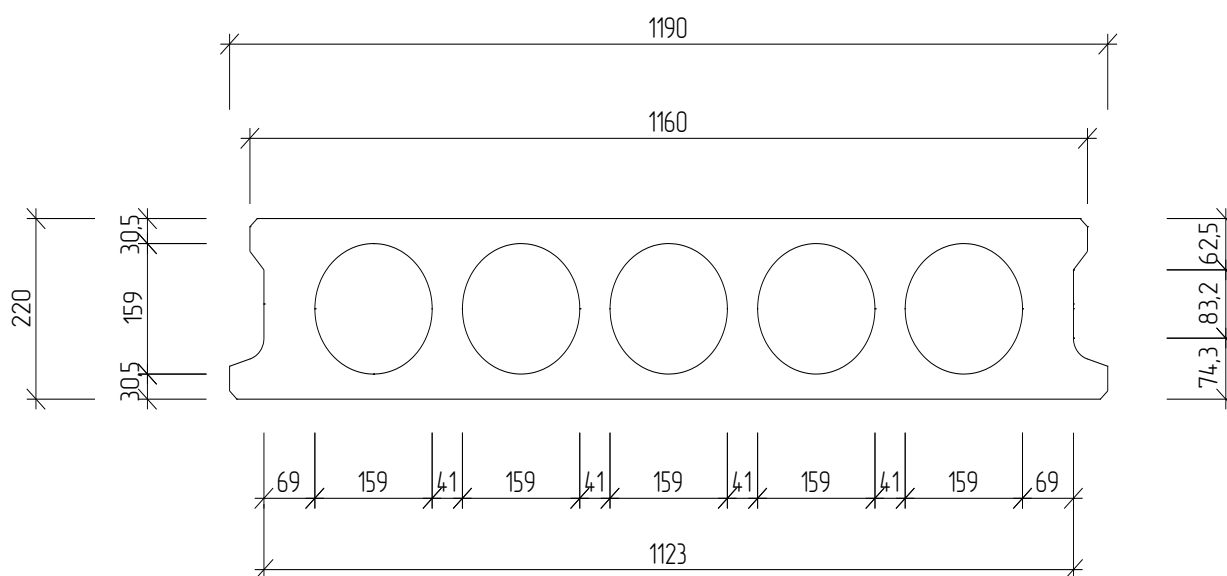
Поперечний переріз багатопустотної плити перекриття
